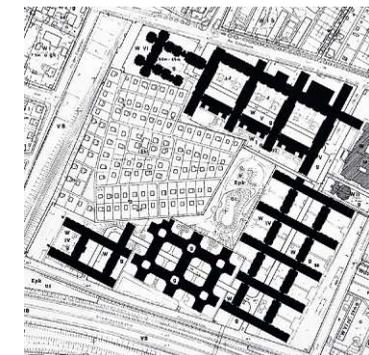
3. Generation: Lageplan Am Schöpfwerk
